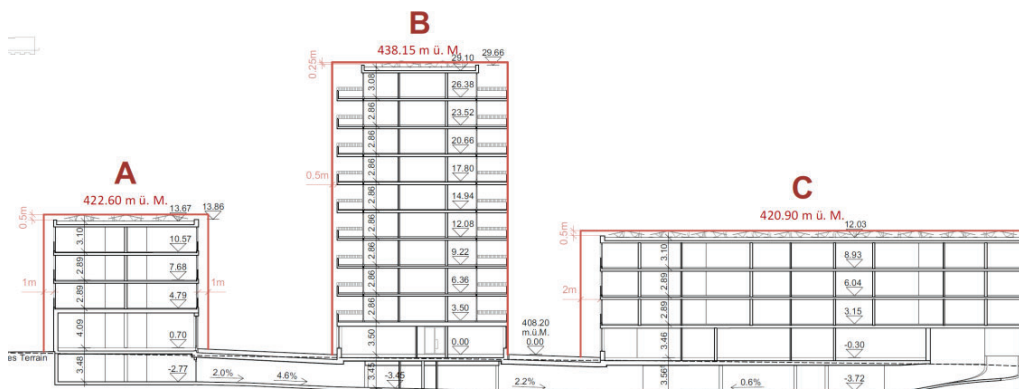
Schnitte der geplanten Gebäude gemäss Gestaltungsplan "Goldernstrasse" (Quelle: Gestaltungsplan Goldernstrasse 2025)
